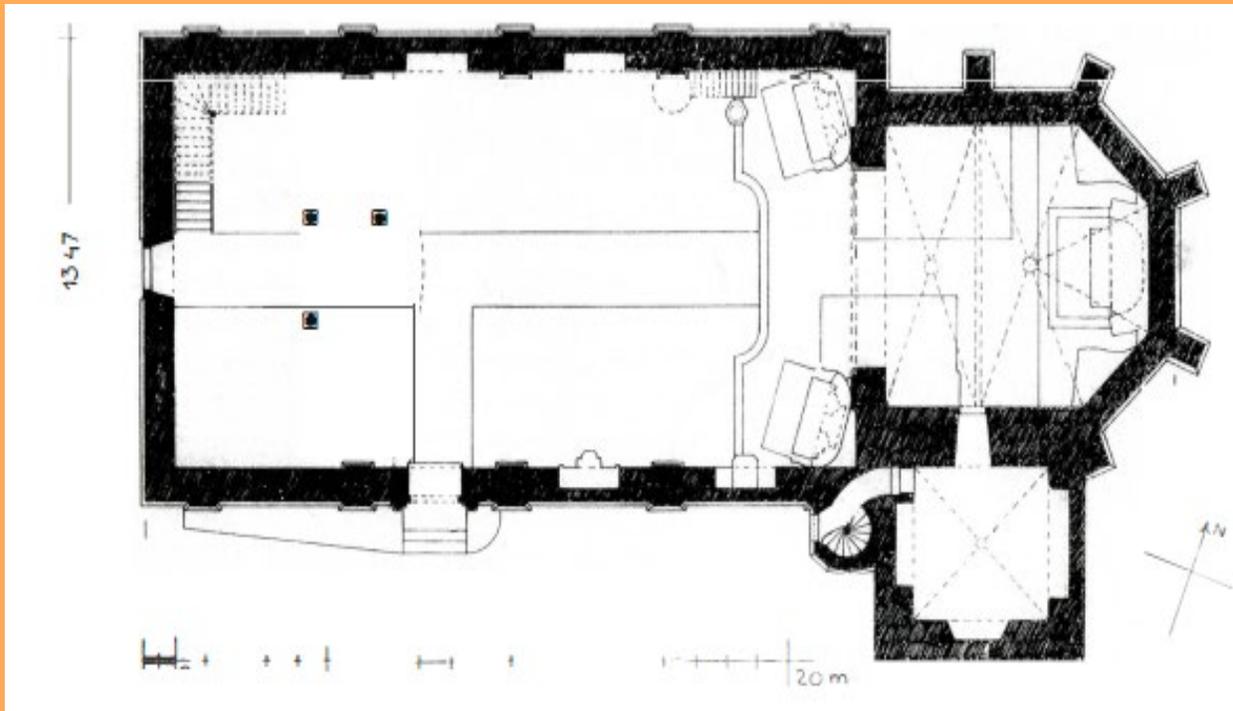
Der Grundriss der Bretzenheimer Pfarrkirche
